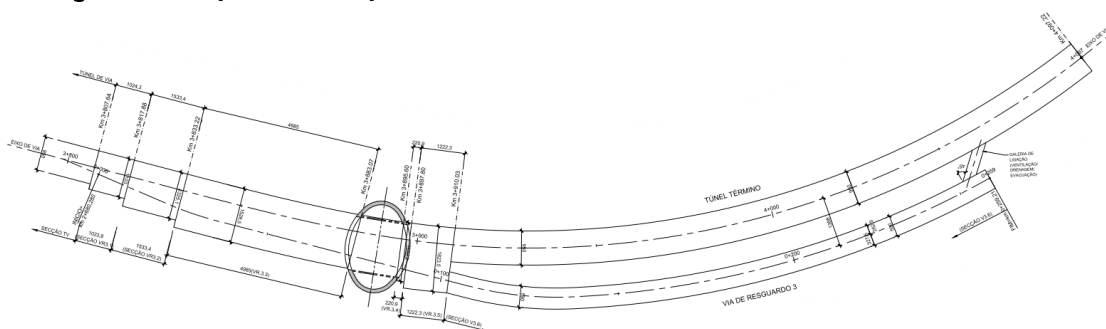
Definição da Via de Resguardo 3. Planta de implantação.
